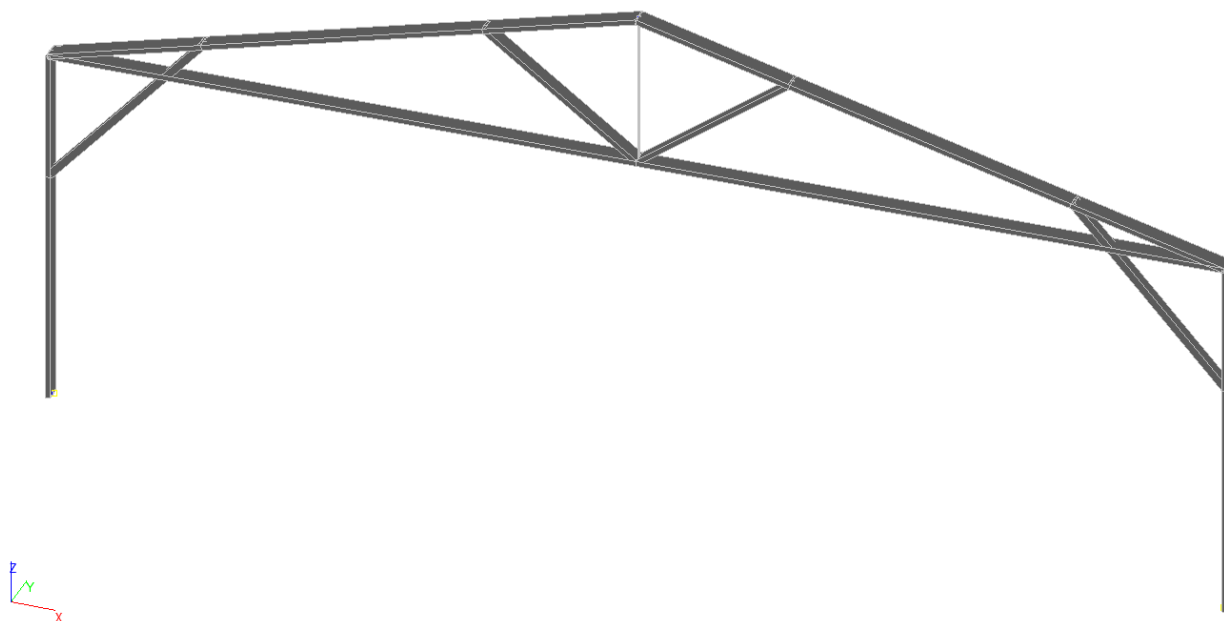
Расчётная схема поперечника здания в пространстве
